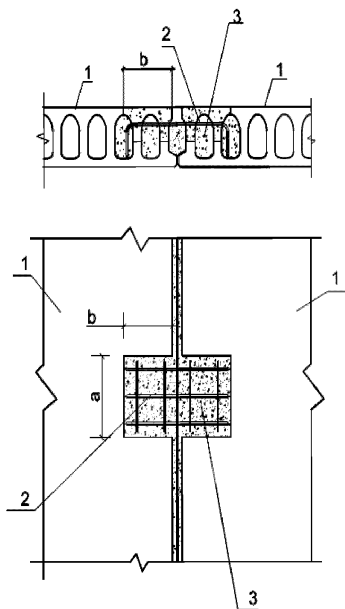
Устройство шпонок в продольных ребрах ПБФ: 1 – плита перекрытия; 2 – каркас; 3 – бетон замоноличивания; а – принимается по расчетам; b – принимается до середины второй пустоты
